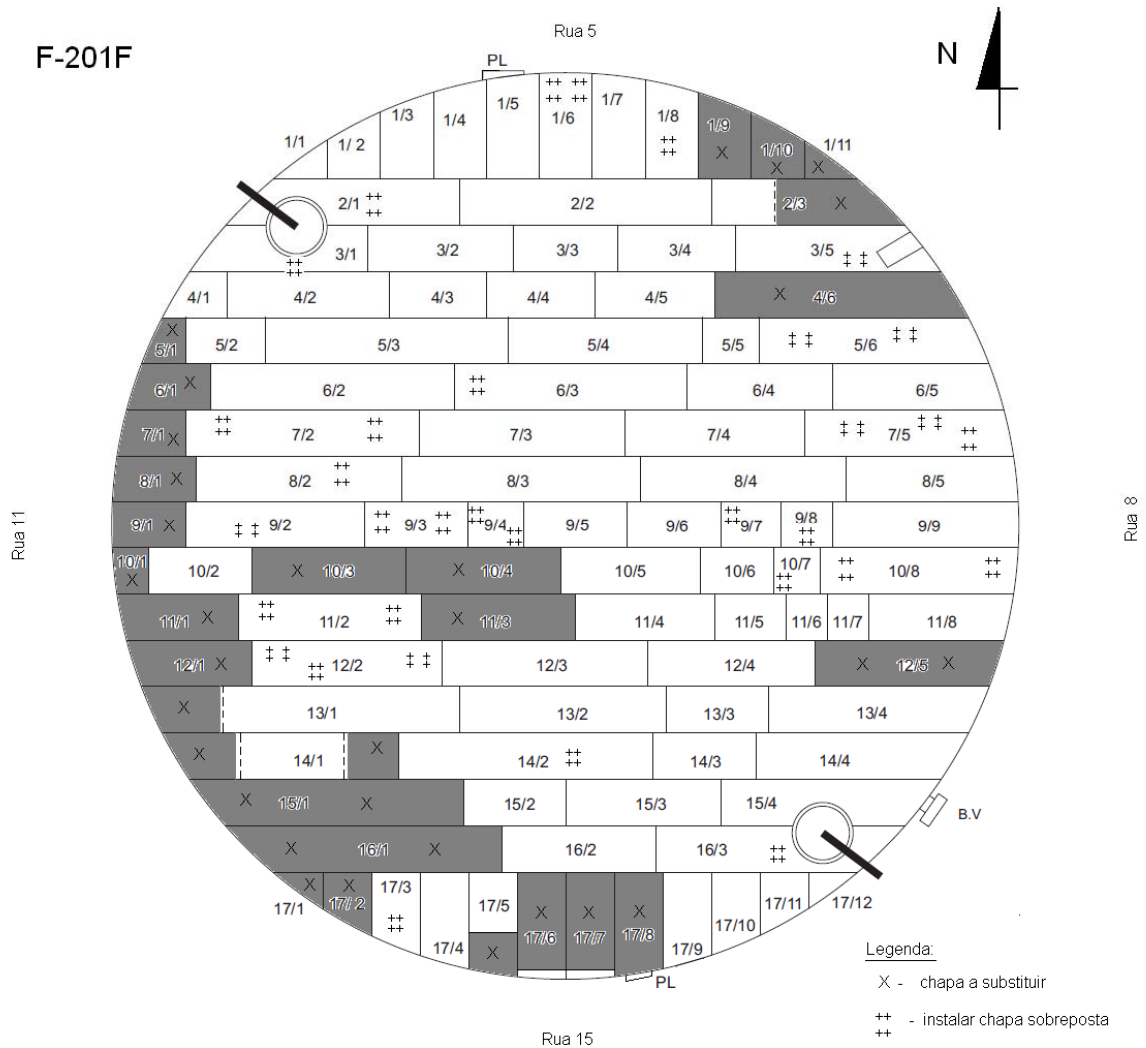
Ilustração esquemática do fundo do tanque com as chapas a substituir e locais para instalação de chapa sobreposta.
